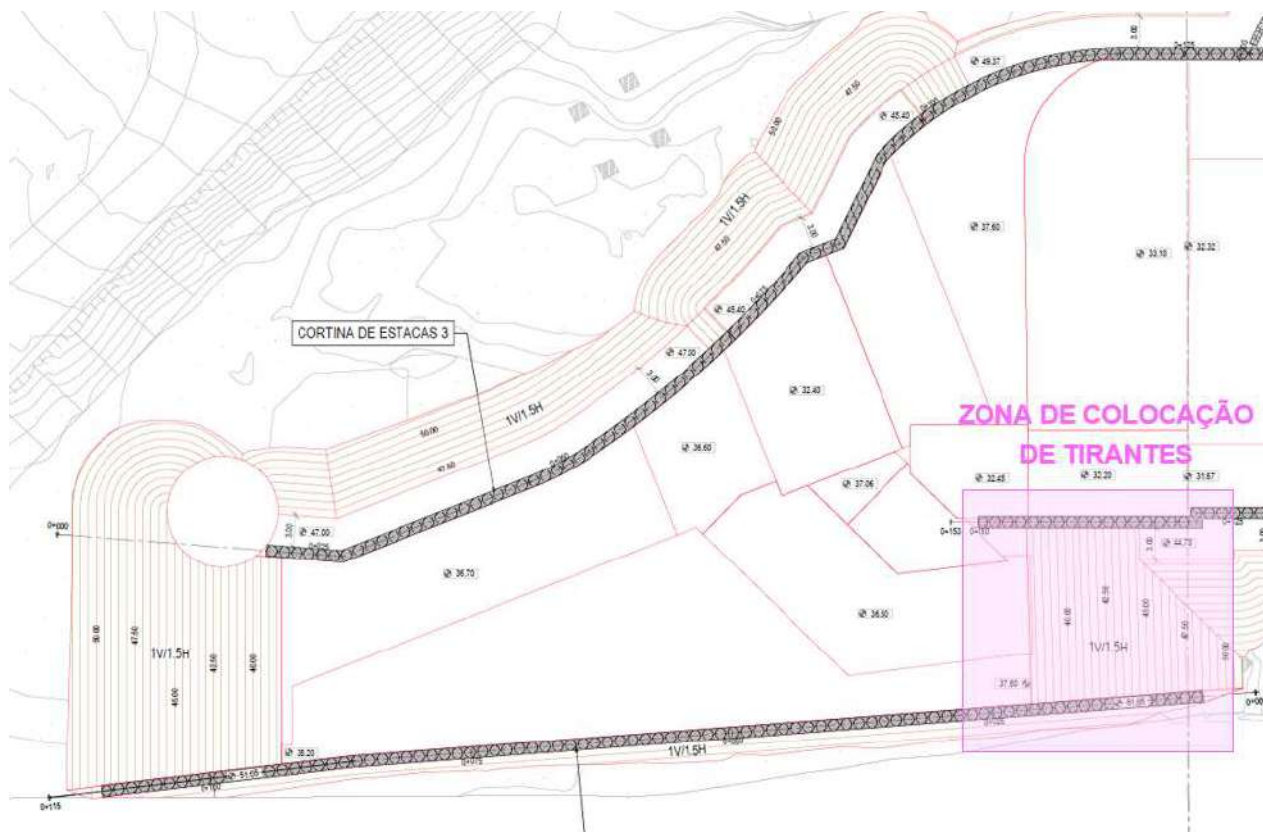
Zona de instalação dos tirantes (em planta).
